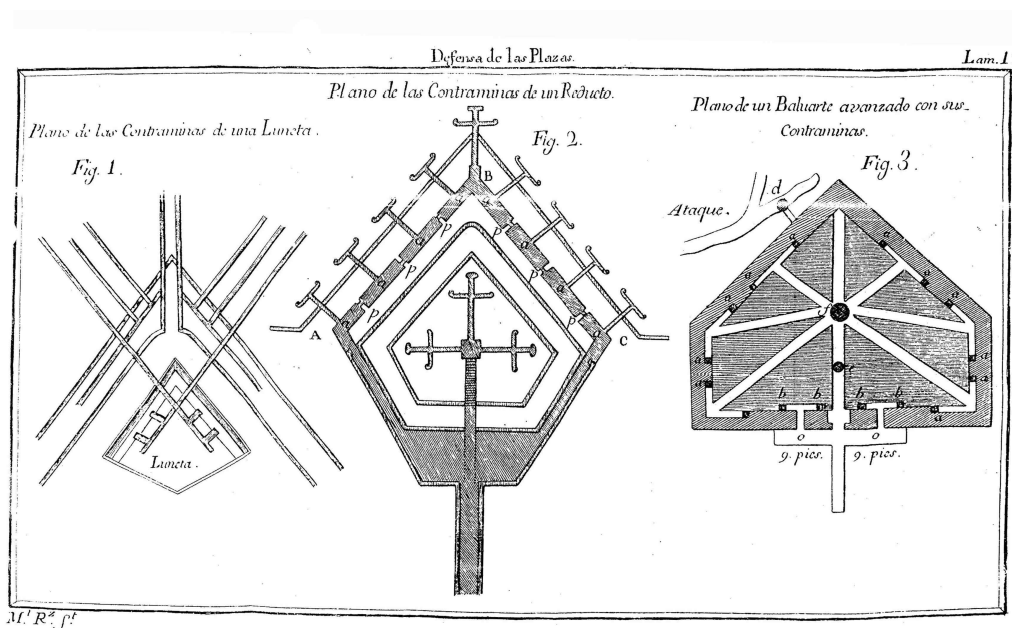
Plano de las contraminas de una luneta, un reducto y de un baluarte avanzado según Le Blond (LE BLOND, Tratado de la defensa de las plazas... (1777) Op. cit. lám. 1.).
